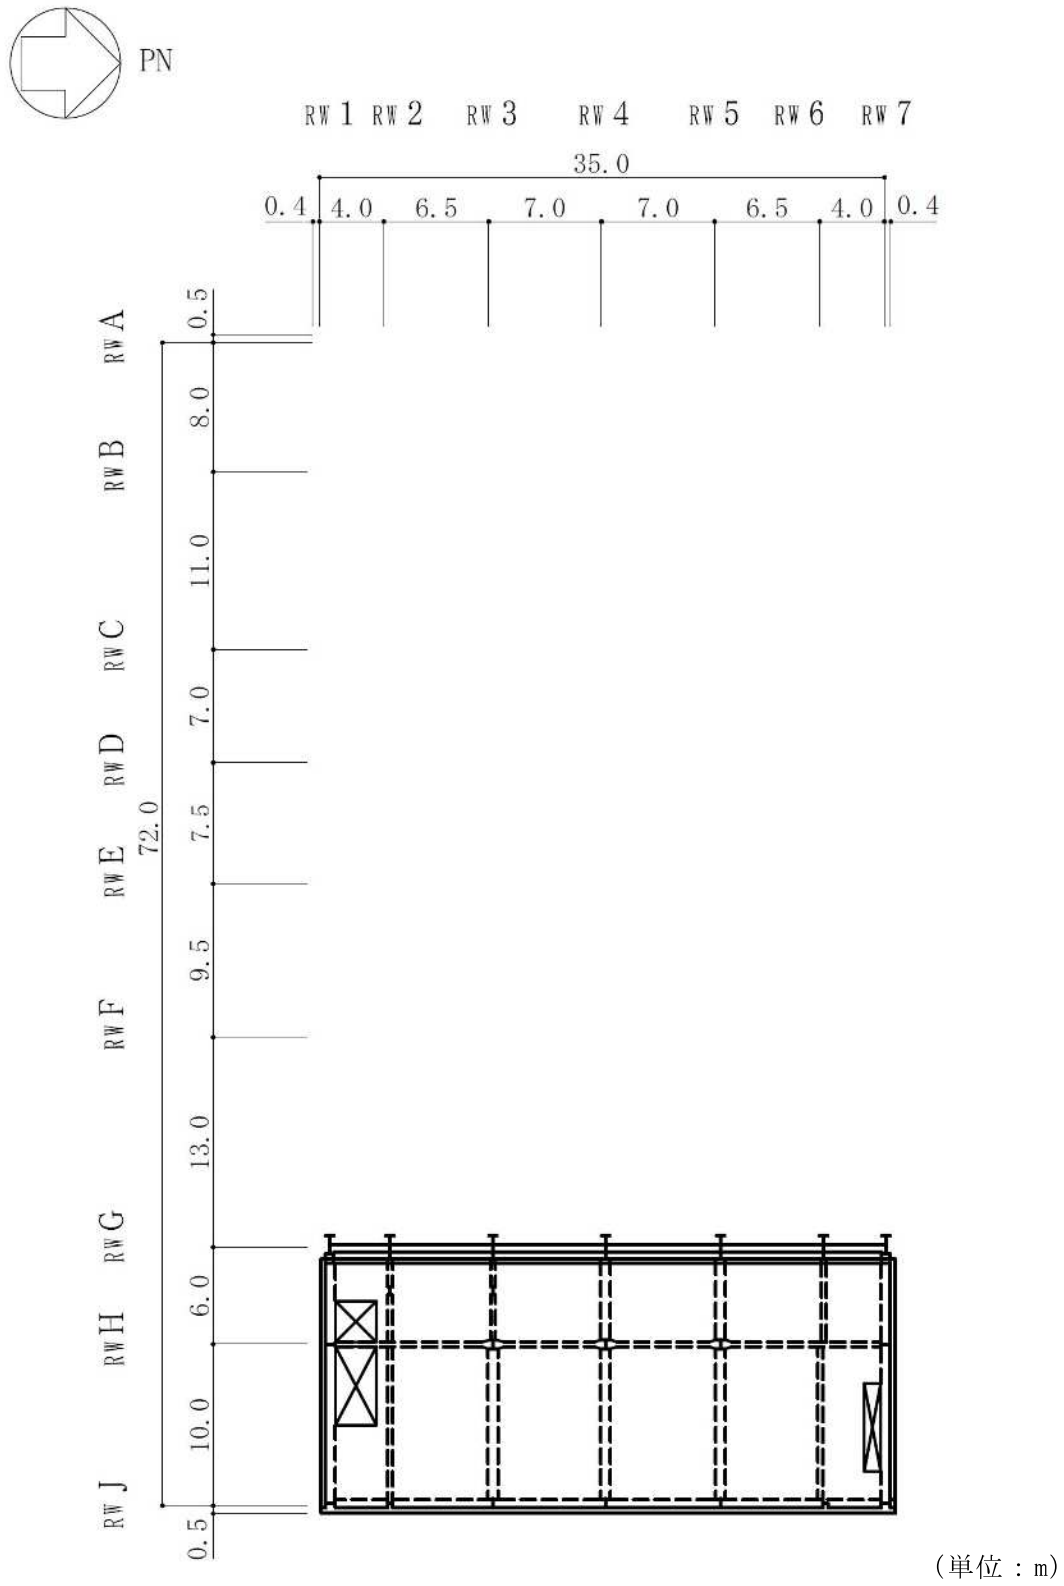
廃棄物処理建屋の概略平面図 (4F, T.M.S.L. 36.7m) (7/8)
